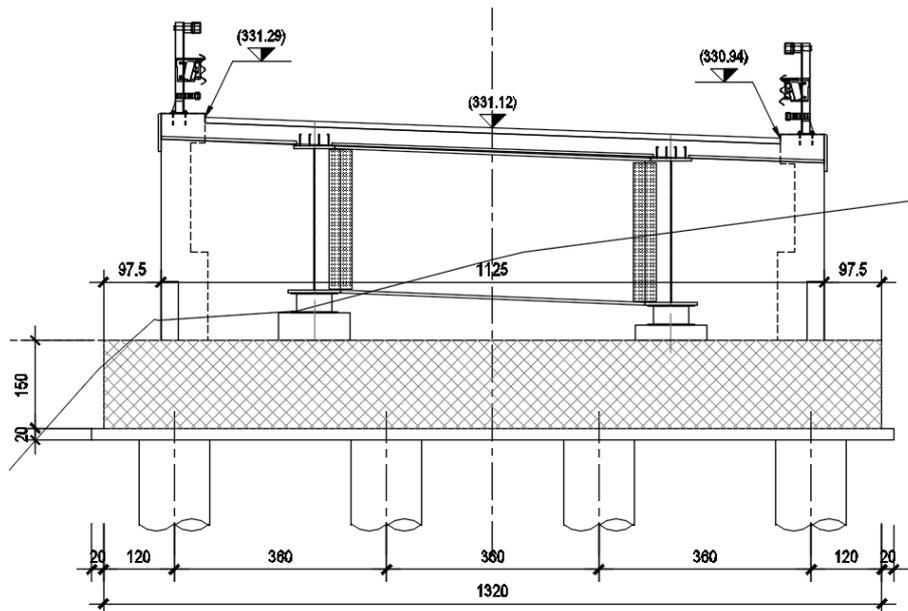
Viadotto Eremita – Sezione su spalla
